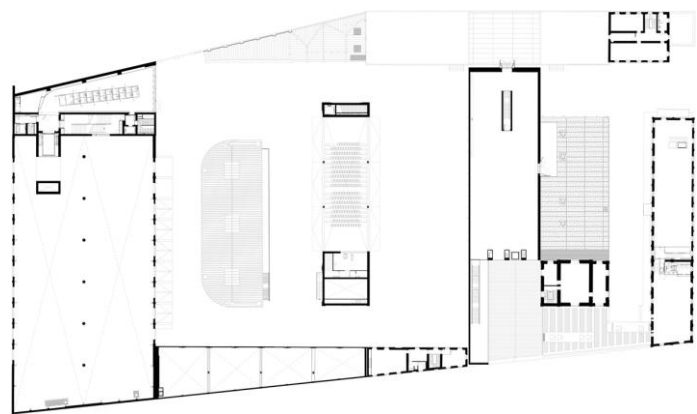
| Planta Fundação Prada | Hic Arquitectura
